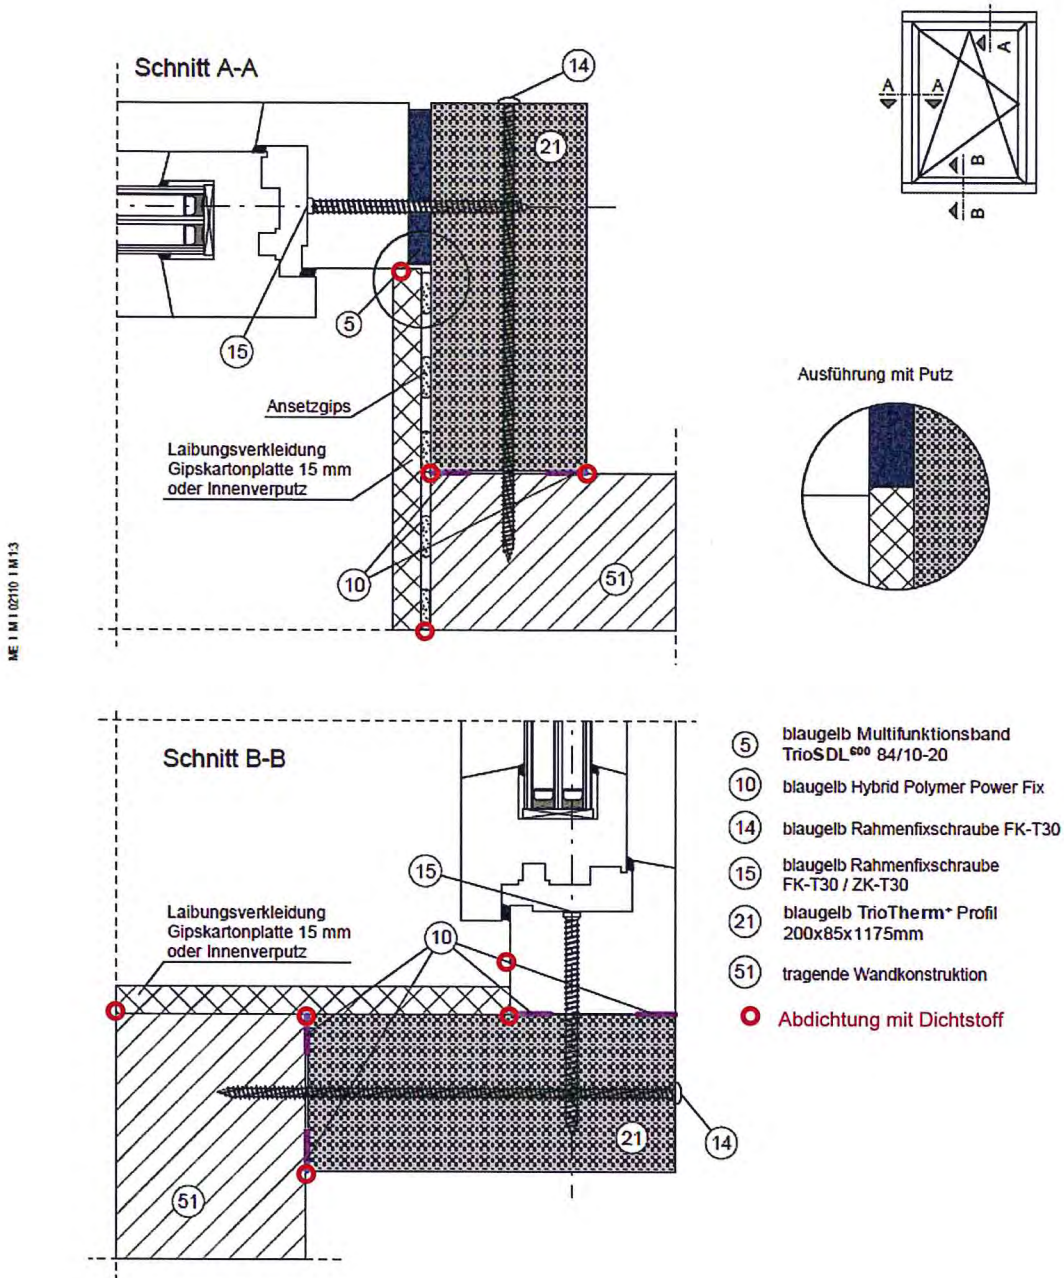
Schnittzeichnung des Herstellers, Anschlussvariante 1 mit Laibungsverkleidung, Grundsatzdetail: Zargenprofil außen und innen mit Dichtstoff zum Prüfstand abgedichtet, Fensterrahmen unten innen mit Dichtstoff zur Zarge abgedichtet, Laibungsverkleidung umlaufend aus GKF (ohne Zwischenlage umlaufende Abdichtung).
